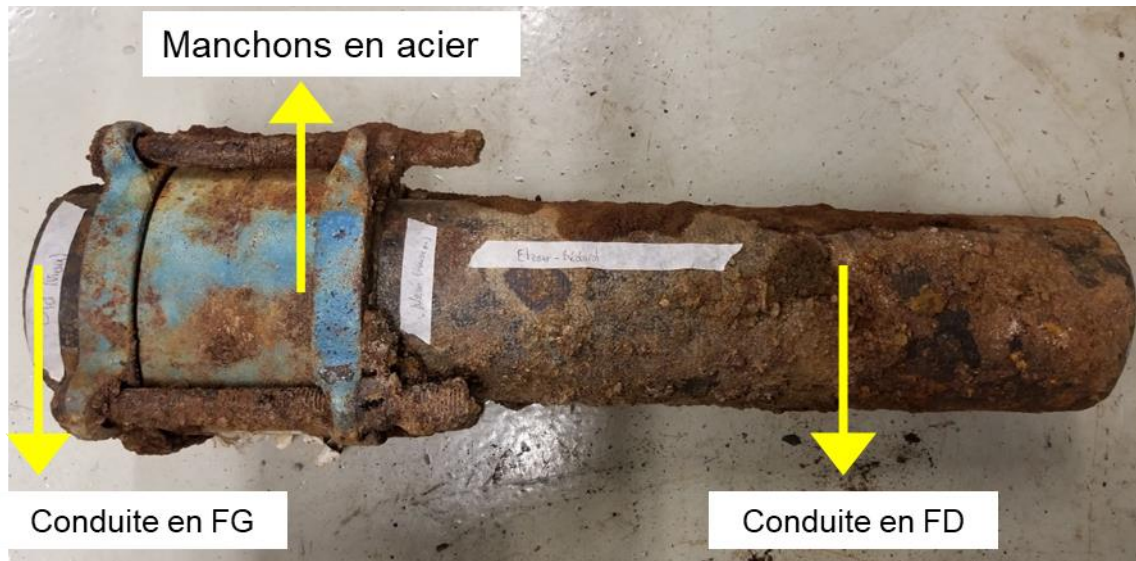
Échantillon M-1 - Conduite en fonte grise et conduite en fonte ductile reliées par un manchon en acier
